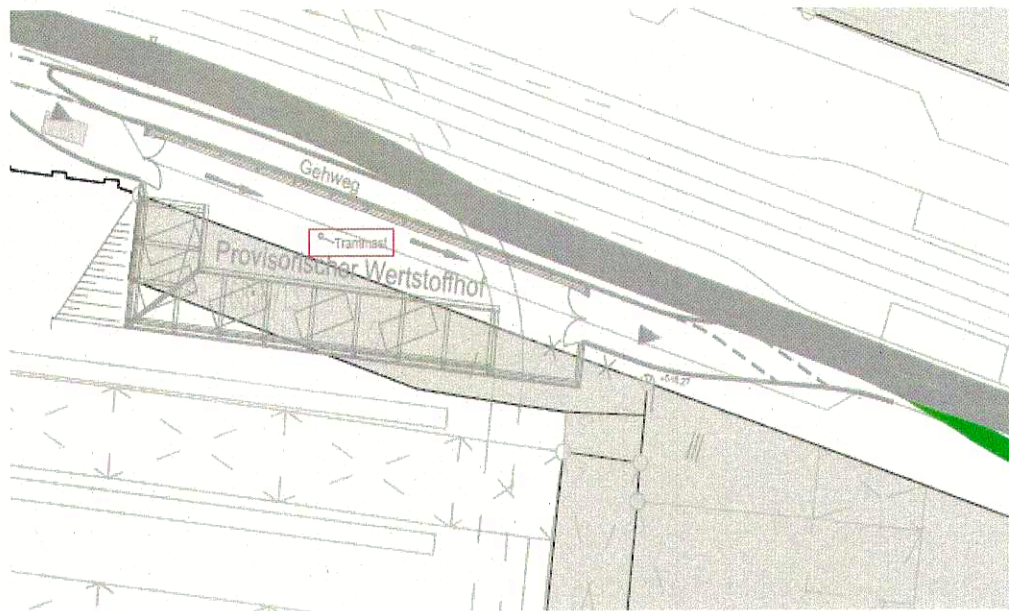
Lageplan, Ausschnitt Baugistikplan (PFA1, Anlage 14-2-2D)
